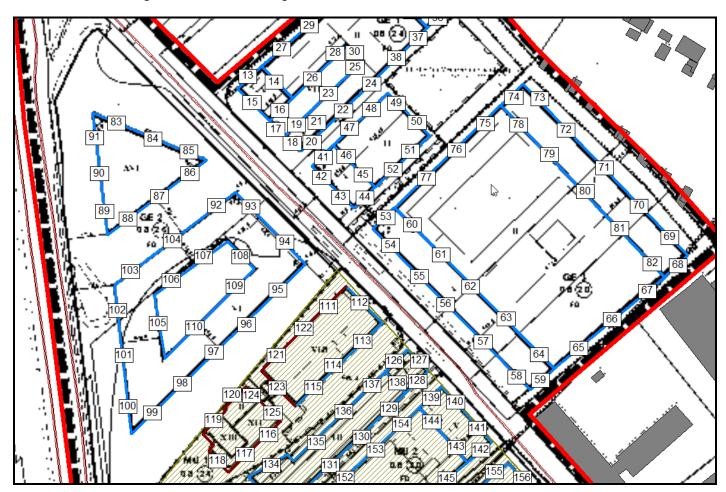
Lage und Nummerierung der Fassadenabschnitte
